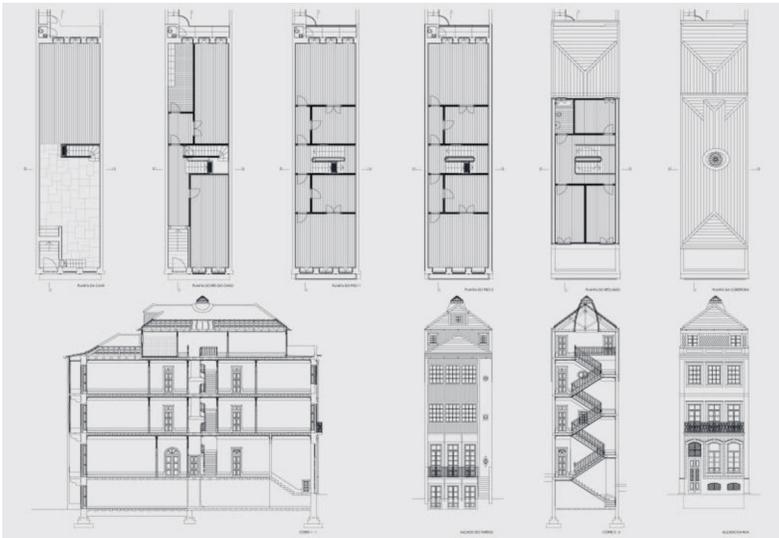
Plantas, cortes e alçados do modelo construtivo das casas burguesas do Porto
